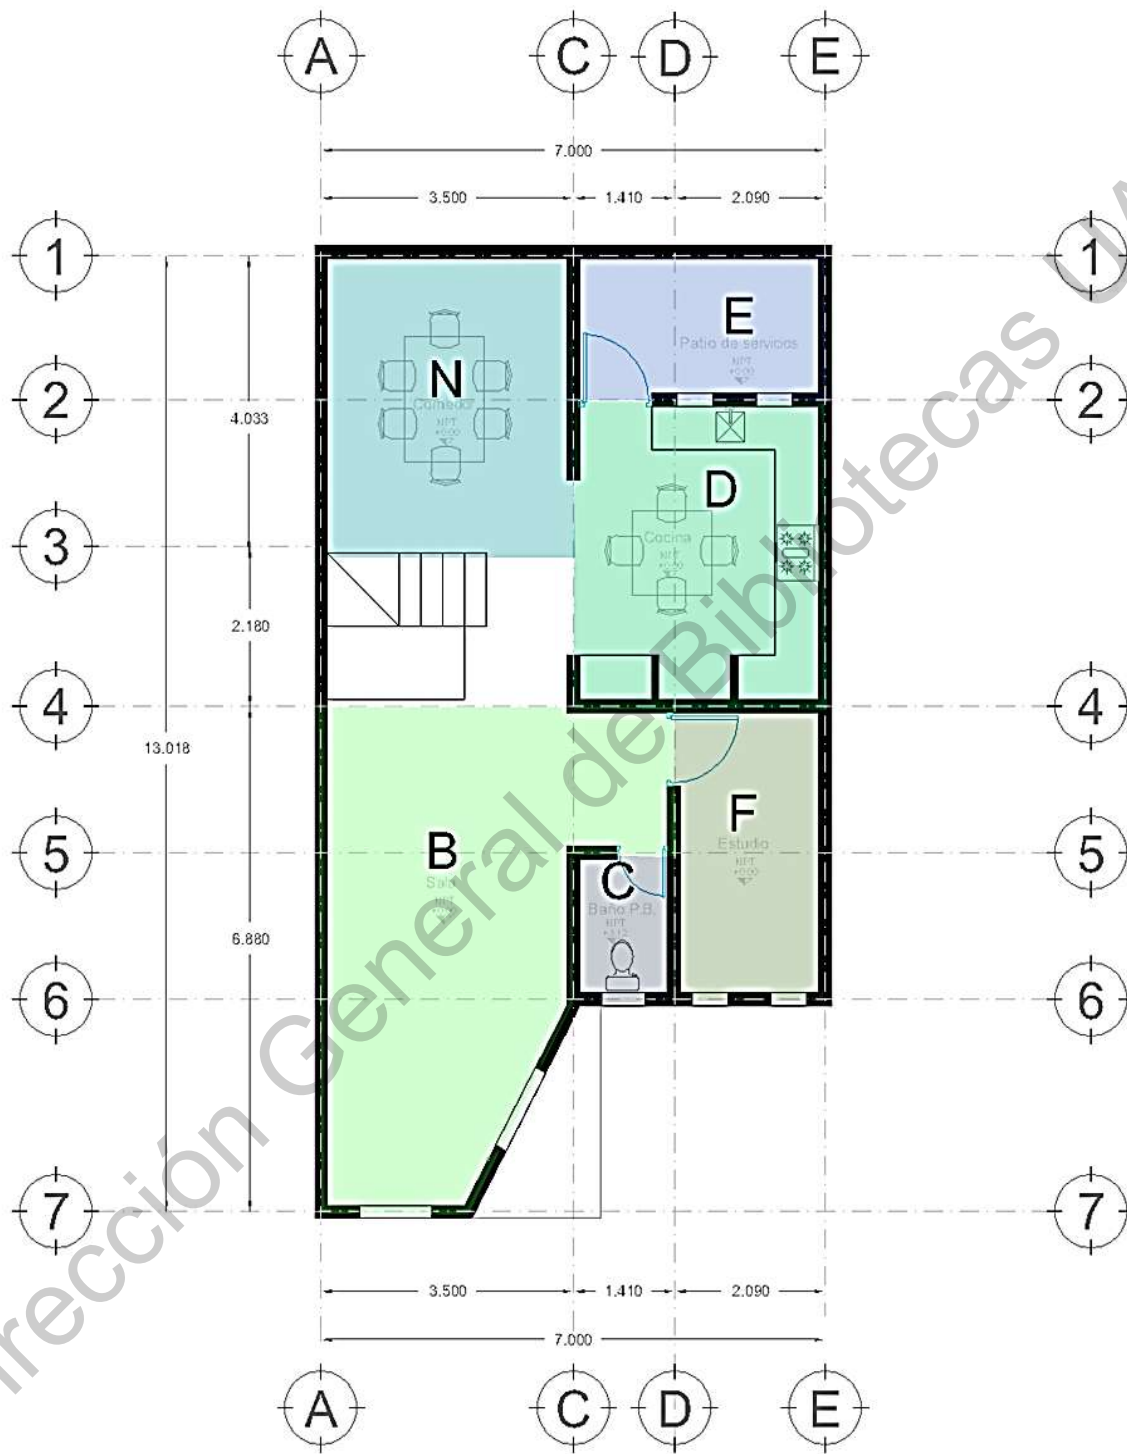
Planta Arquitectónica Baja. Zonificación Ecotect.
